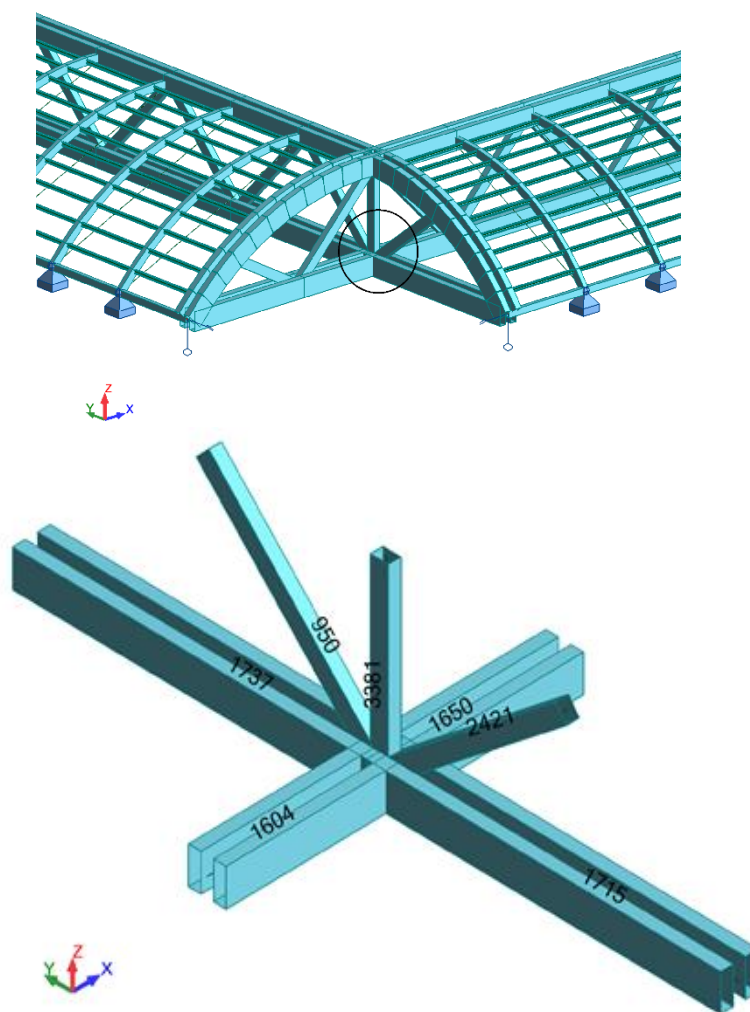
Identificação das barras da ligação entre vigas principais
